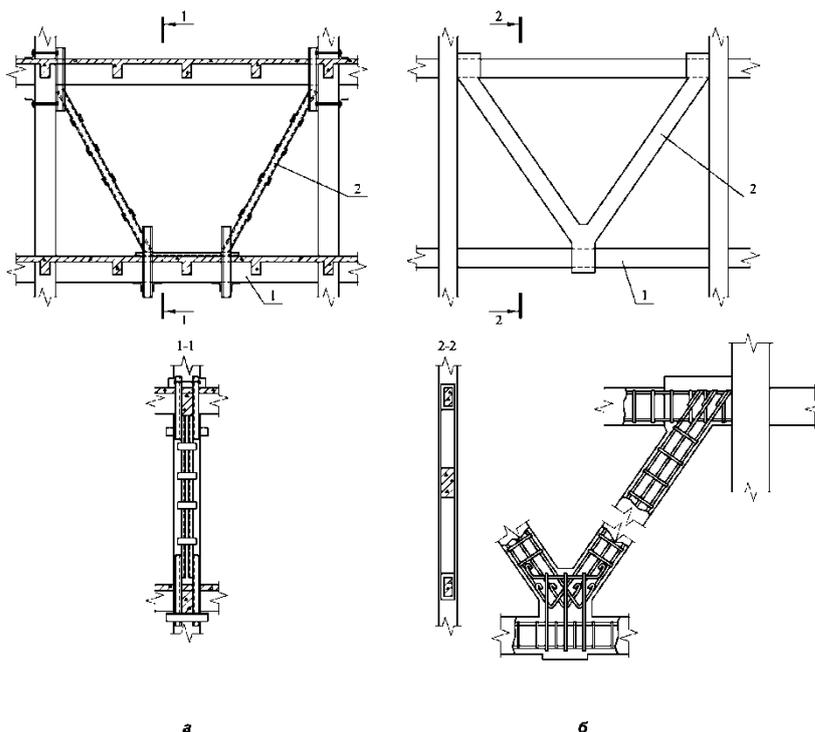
Схема усиления балки перекрытия с устройством опор в виде подвесок: а – стальных; б – железобетонных; 1 – усиливаемый элемент; 2 – подвеска; 3 – арматура подвески
